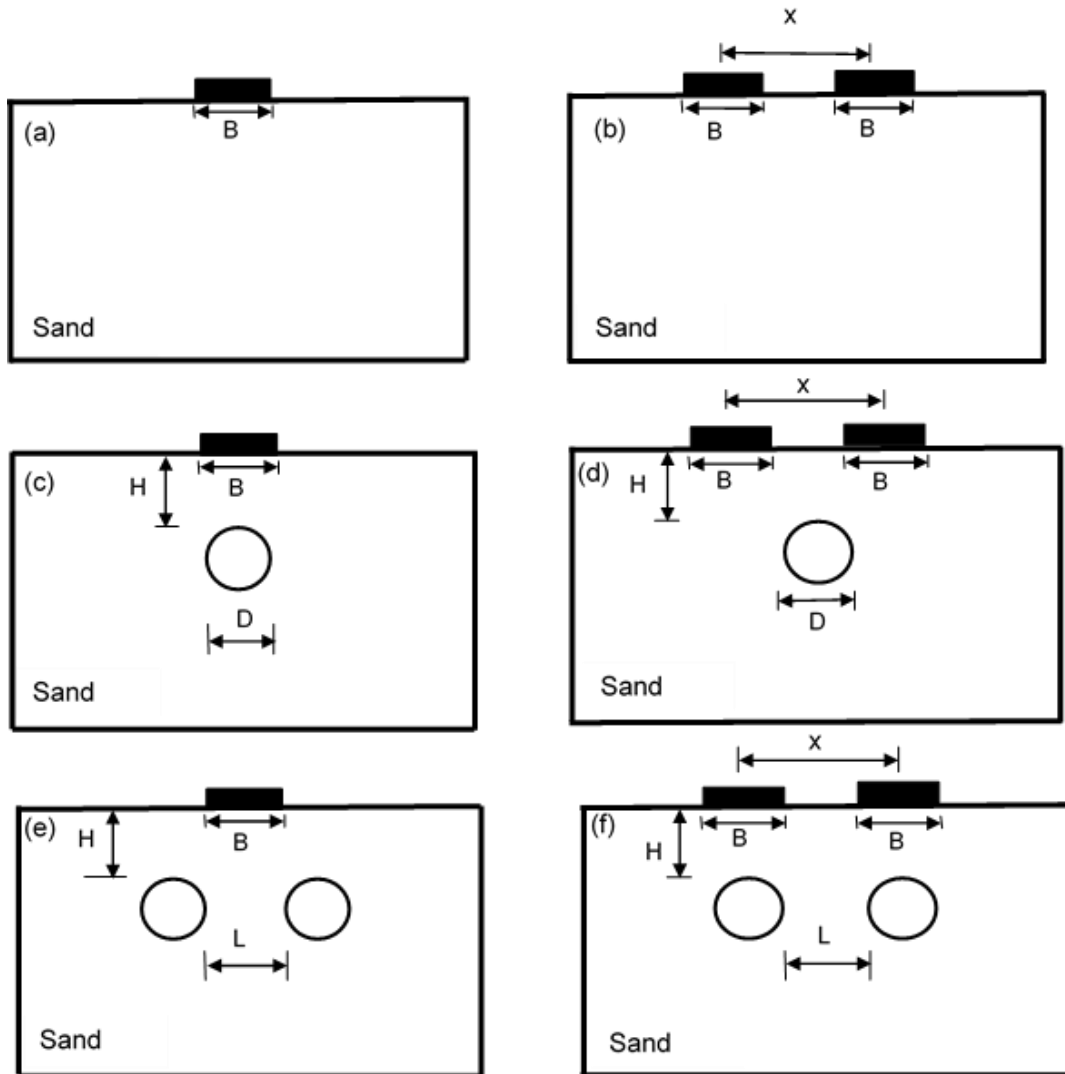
Modèles utilisés dans cette étude: (a) semelle isolée; (b) deux semelles filantes adjacentes; (c) semelle isolée avec cavité; (d) deux semelles filantes adjacentes avec cavité; (e) semelle isolée avec deux cavités; (f) deux semelles filantes adjacentes avec deux cavités.
